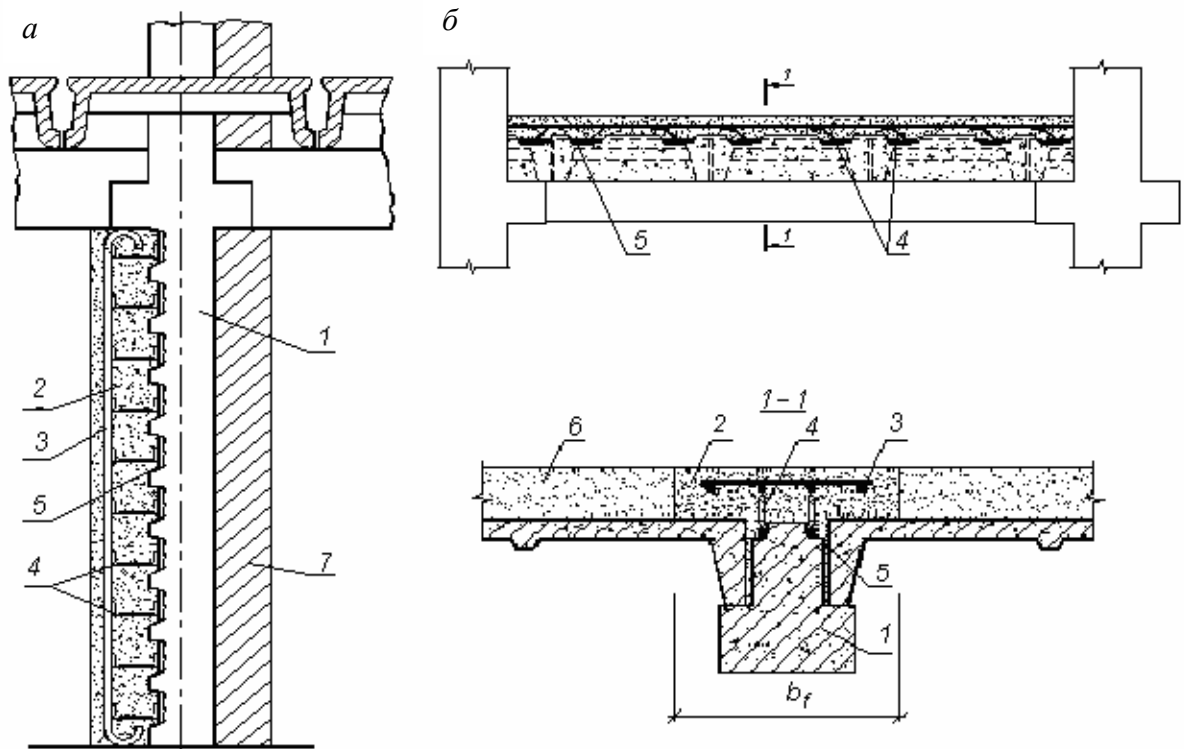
Усиление сжатой зоны конструкций наращиванием с установкой дополнительной арматуры: *а* – крайней колонны; *б* – сборного ригеля; 1 – усиливаемая конструкция, 2 – бетон наращивания, 3 – дополнительная арматура, 4 – скобы, 5 – оголенная арматура, 6 – легкий бетон, 7 – наружная стена
